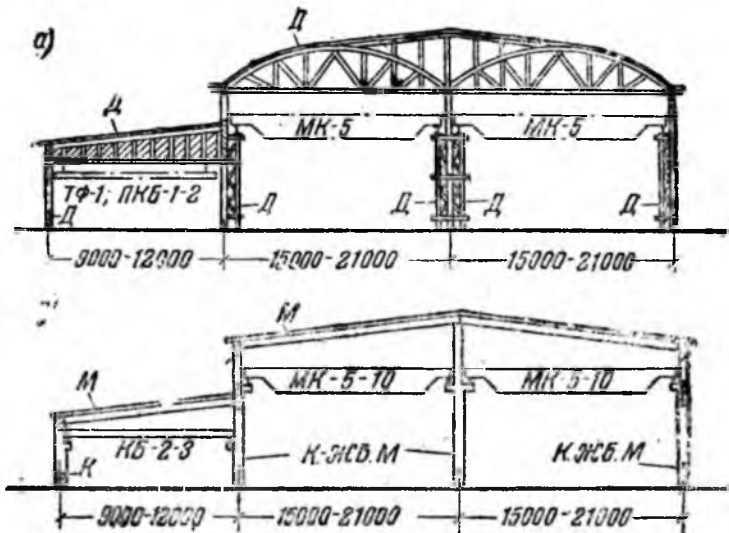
Схемы типовых секций одноэтажных промышленных зданий с наружным отводом воды: Д—дерево; К—кирпич; ЖБ—железобетон; М—металл; тф — тельфер; кб — кран-балка; МК — мостовой кран
